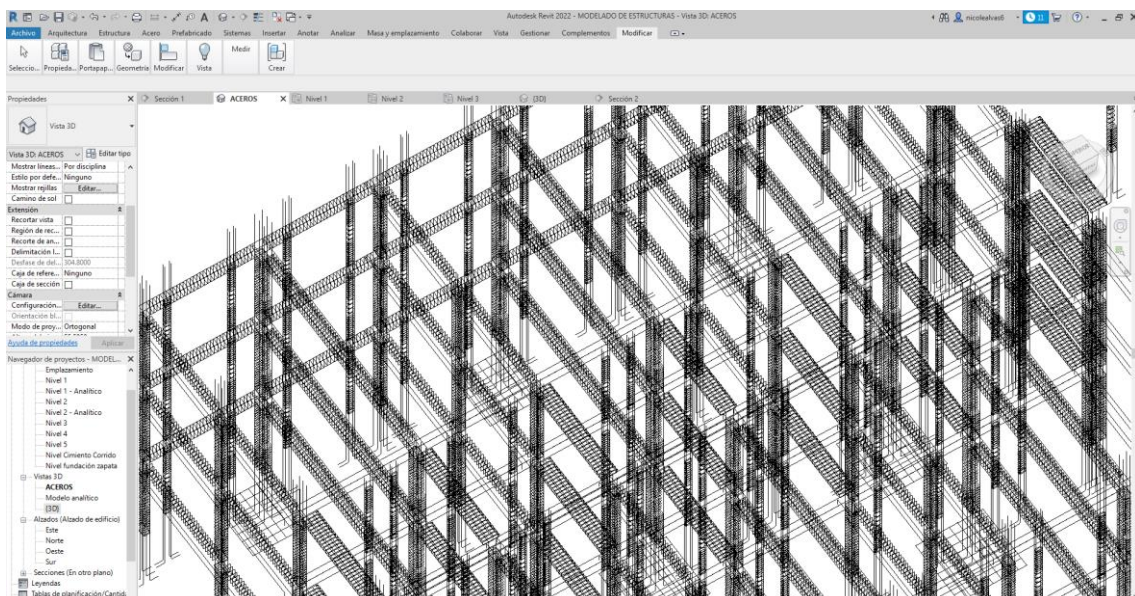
Visualización en 3D del refuerzo estructural de vigas
